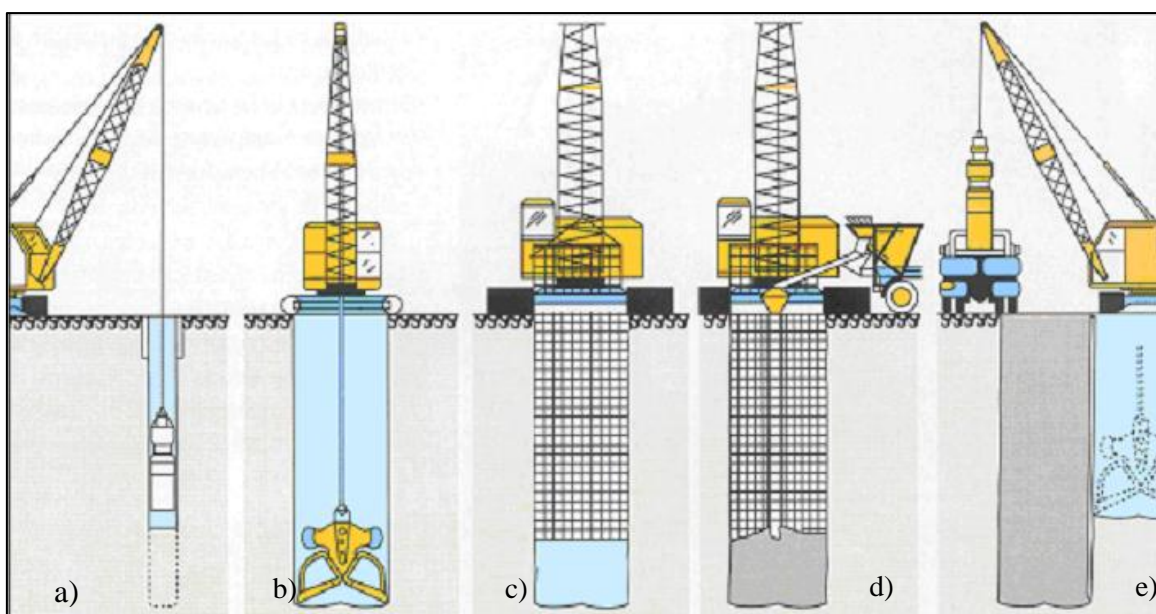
Fases de execução de uma parede moldada: a),b) escavação; c) colocação da armadura e tubos de junta; d) betonagem; e) início da escavação do painel seguinte (Moreira, Carlos, 2012)
